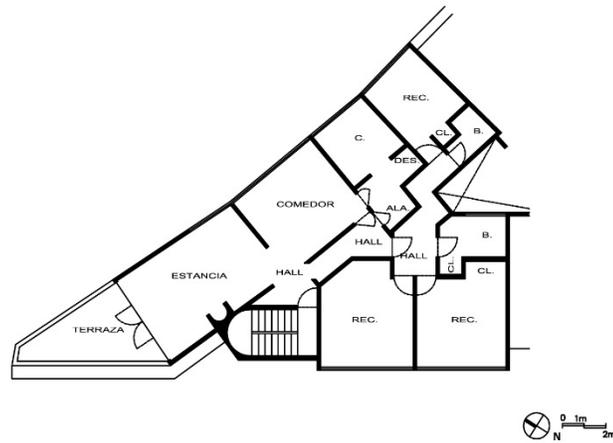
Planta tipo del departamento de mayores dimensiones del edificio ubicado en Melchor Ocampo núm. 64
